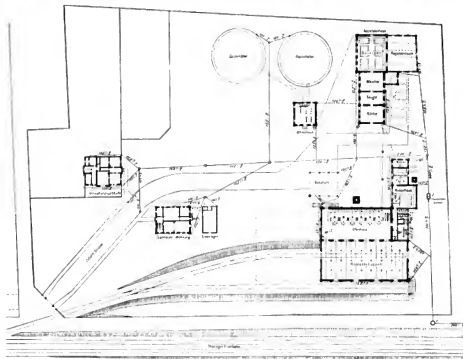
Lageplan der neuen Gasanstalt in Eisenach. Maassstab 1 : 1000.
